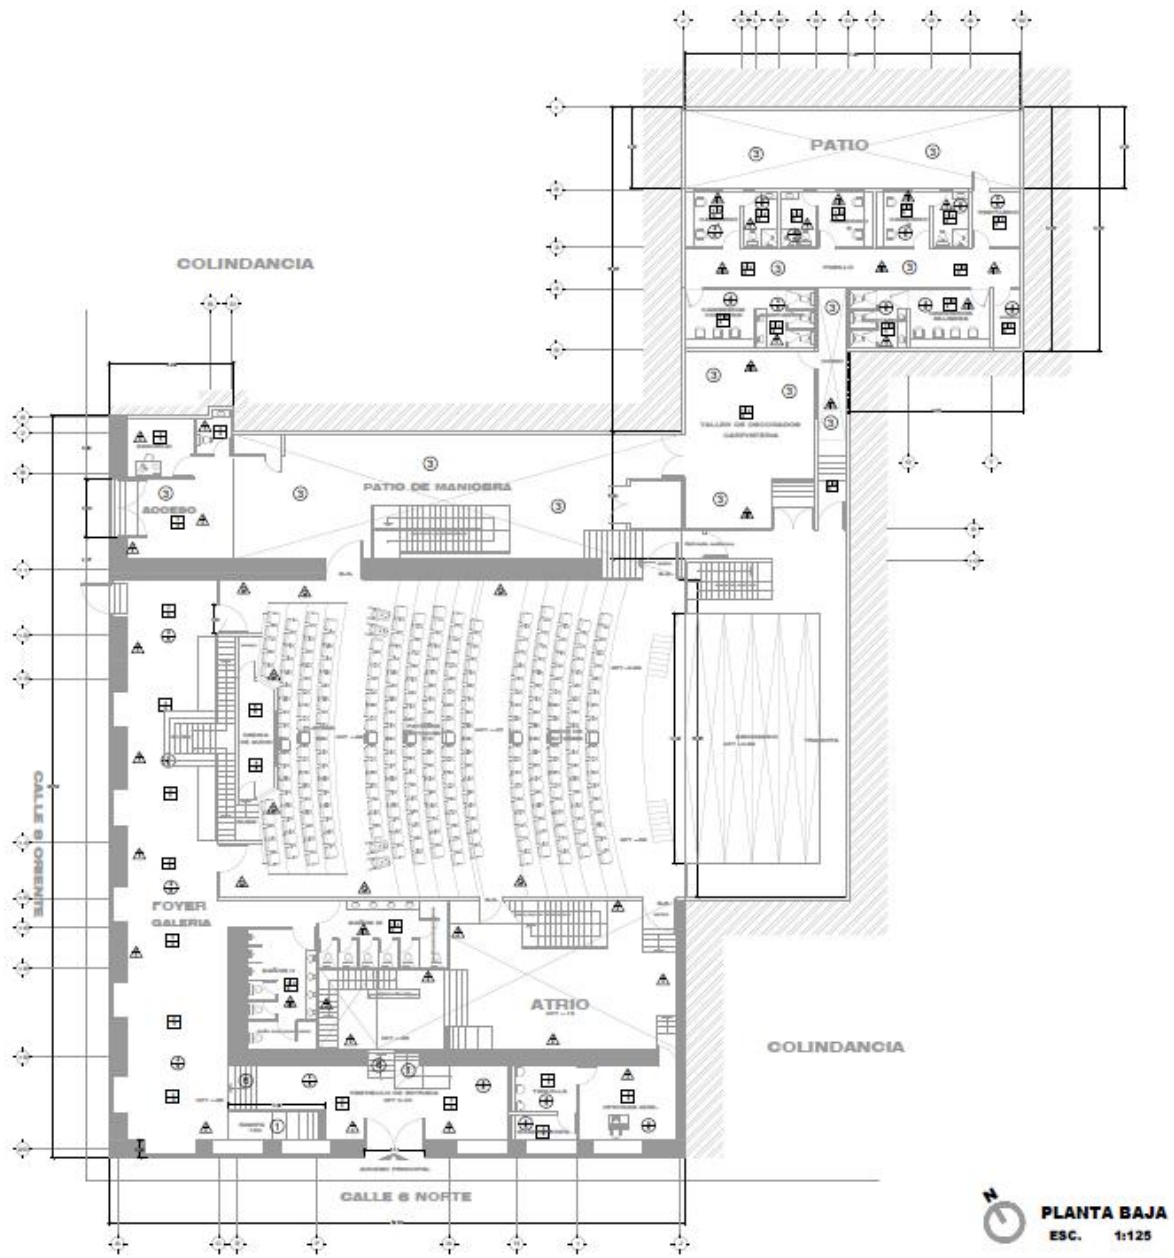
Planta baja arquitectónica acabados. (Fuente: Propia).
